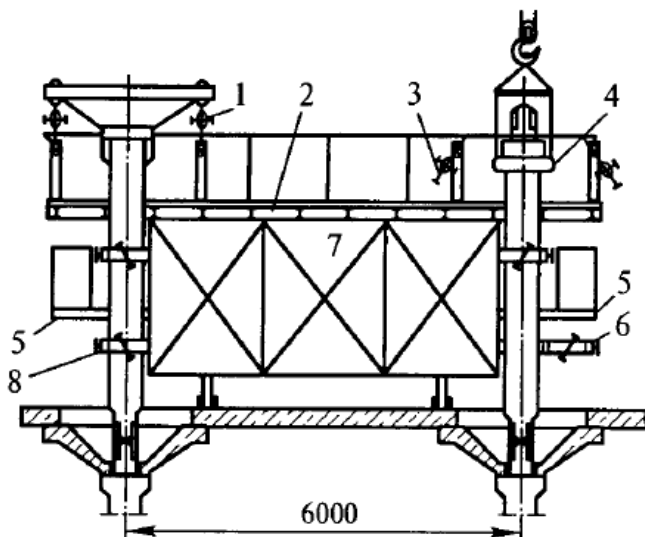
Кондуктор для монтажа безбалочных перекрытий: 1 — рабочее положение винтов для выверки капителей; 2 — рабочая площадка; 3 — нерабочее положение винтов; 4 — траверса для подъема колонн; 5 — откидные площадки; 6 — хомут незакрепленный; 7 — рама кондуктора; 8 — хомут закрепленный
